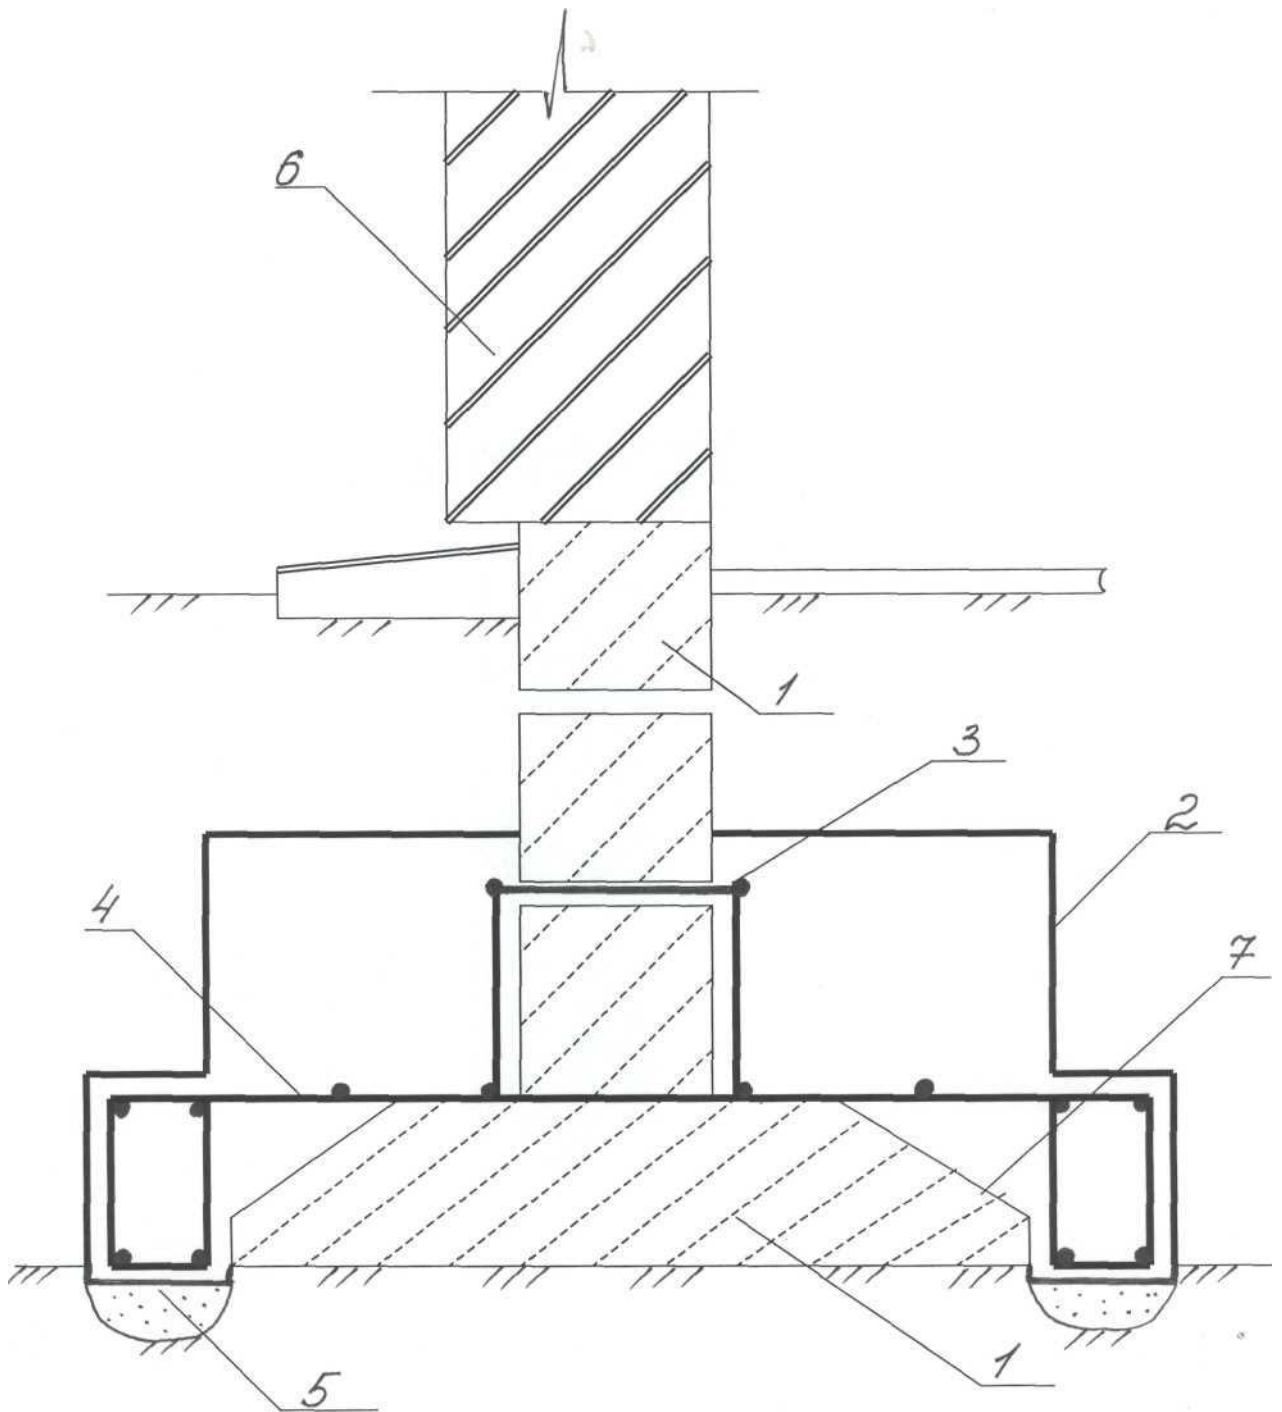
Увеличение опорной площади фундамента устройством железобетонной обоймы
